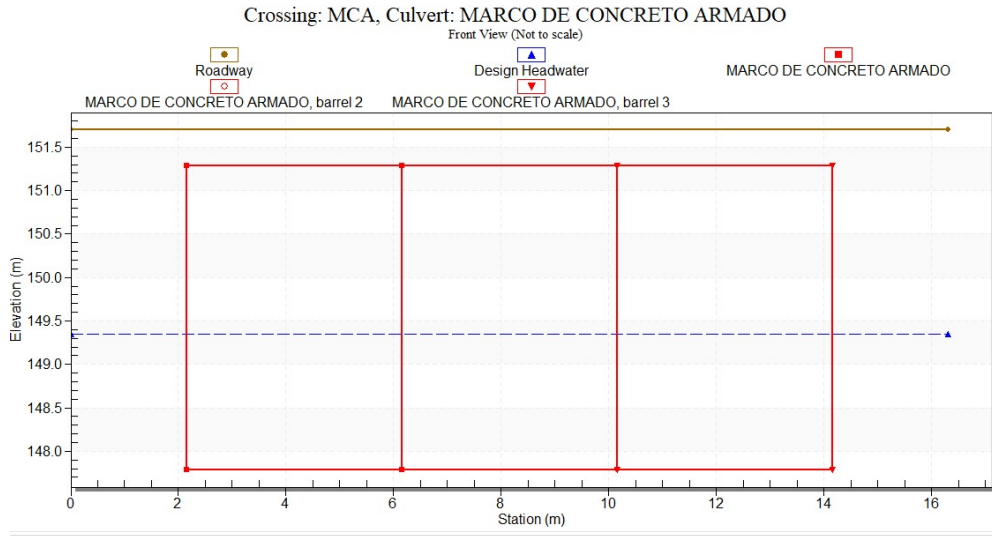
Esquema del flujo en vista frontal del marco de concreto armado. Fuente: Elaboración propia.
